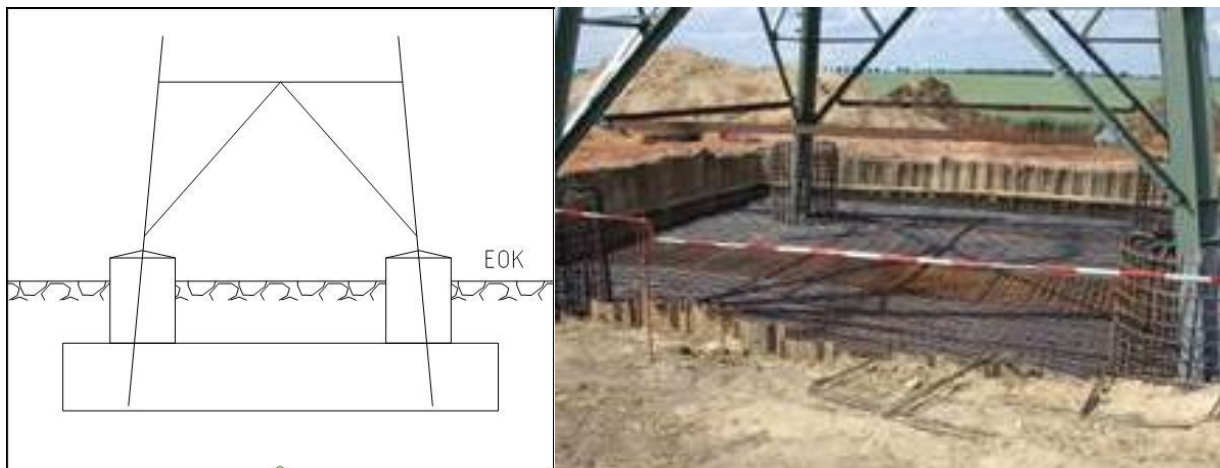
Plattenfundament - Prinzipzeichnung (l.) und Bauausführung (r.)
